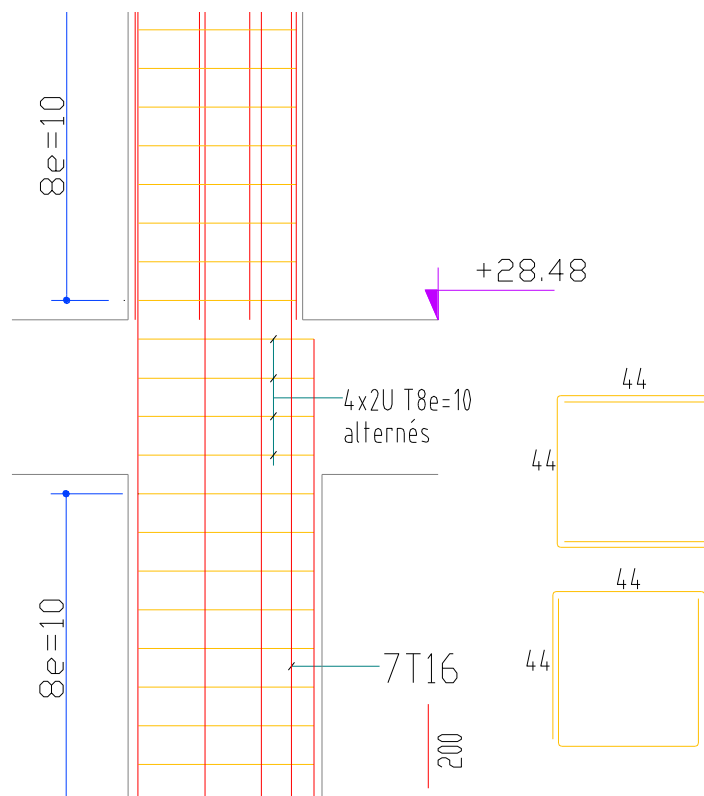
Ferrailage de recouvrement des poteaux 50 × 50 cm² avec les poteaux 45 × 45 cm².
